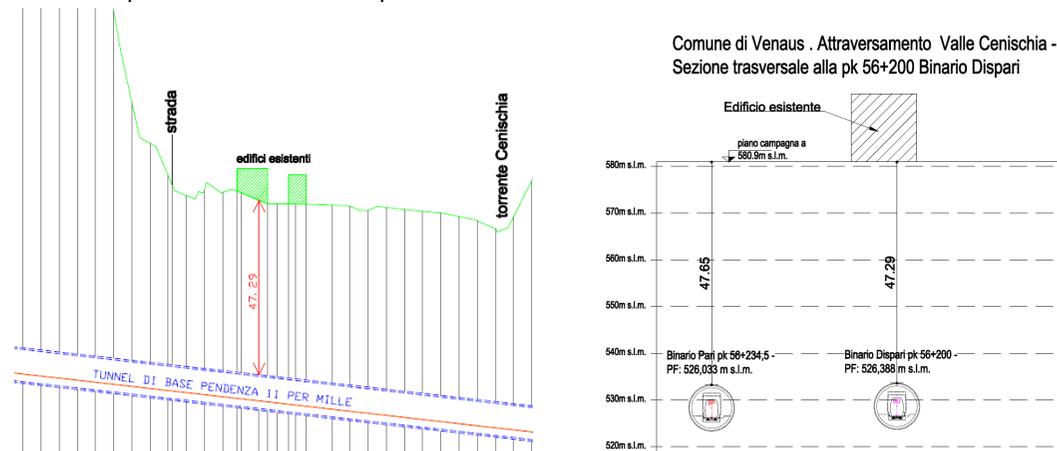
Tunnel di Base - Stralcio Sottoattraversamento Venaus - Planimetria + Profilo
